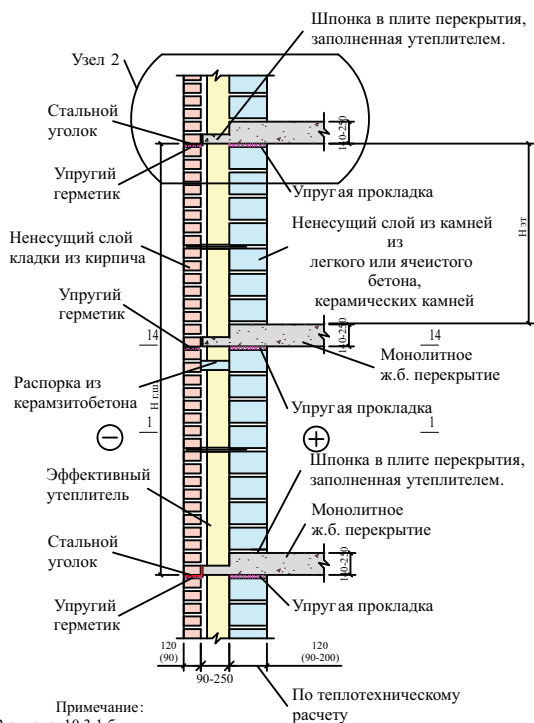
а. Наружная стена для зданий высотой 1-30 этажей с ненесущим наружным слоем из кирпича, керамических или силикатных камней толщиной 12 см, устанавливаемым на стальной уголок и внутренним несущим слоем, устанавливаемым на перекрытие (ГН-1)
